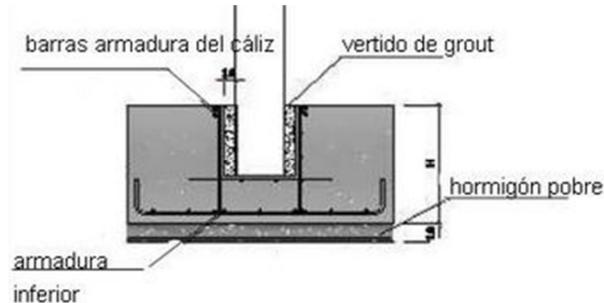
Zapata con cáliz para empotramiento de columna prefabricada
